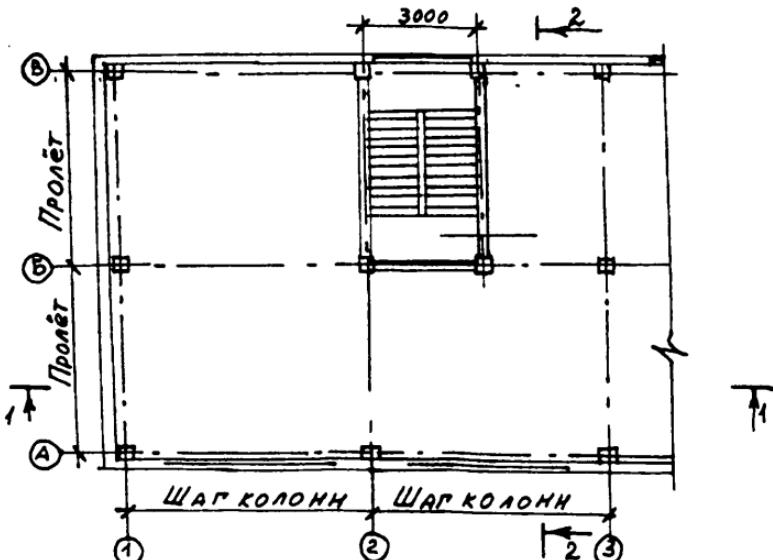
Фрагмент плана многоэтажного двухпролетного здания
